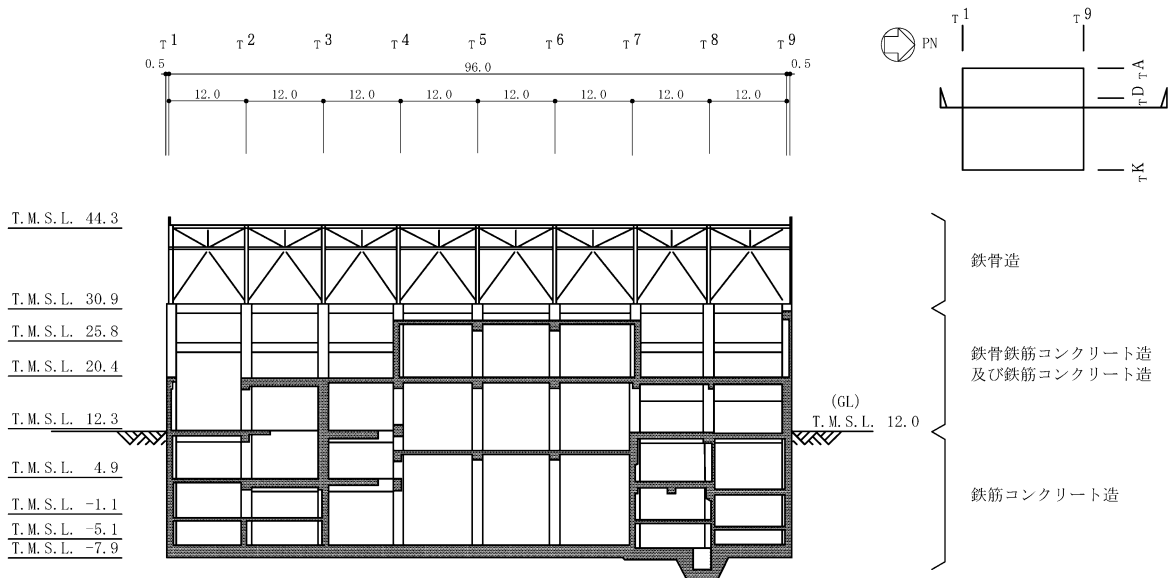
タービン建屋の概略断面図 (NS 方向) (1/2) (単位 : m)
